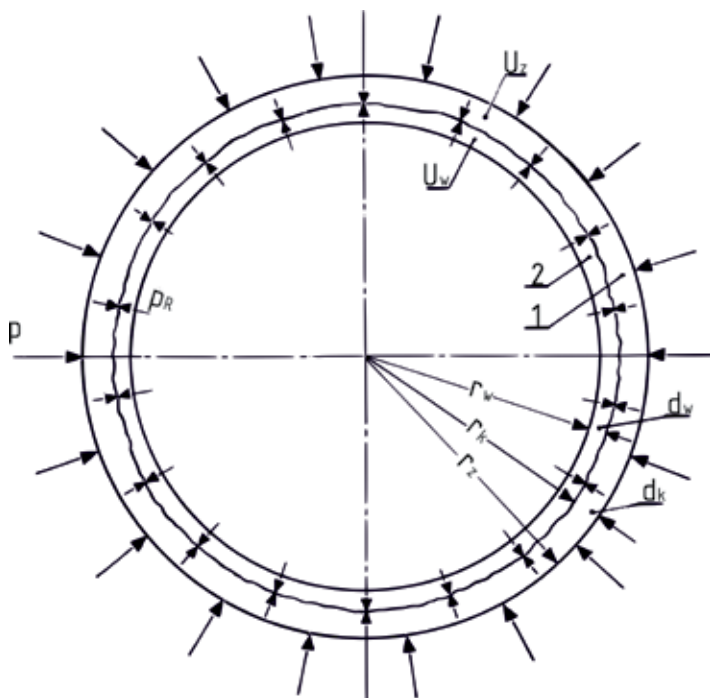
Obudowa zespolona trójpierścieniowa (tubingowo-betonowo-tubingowa).
